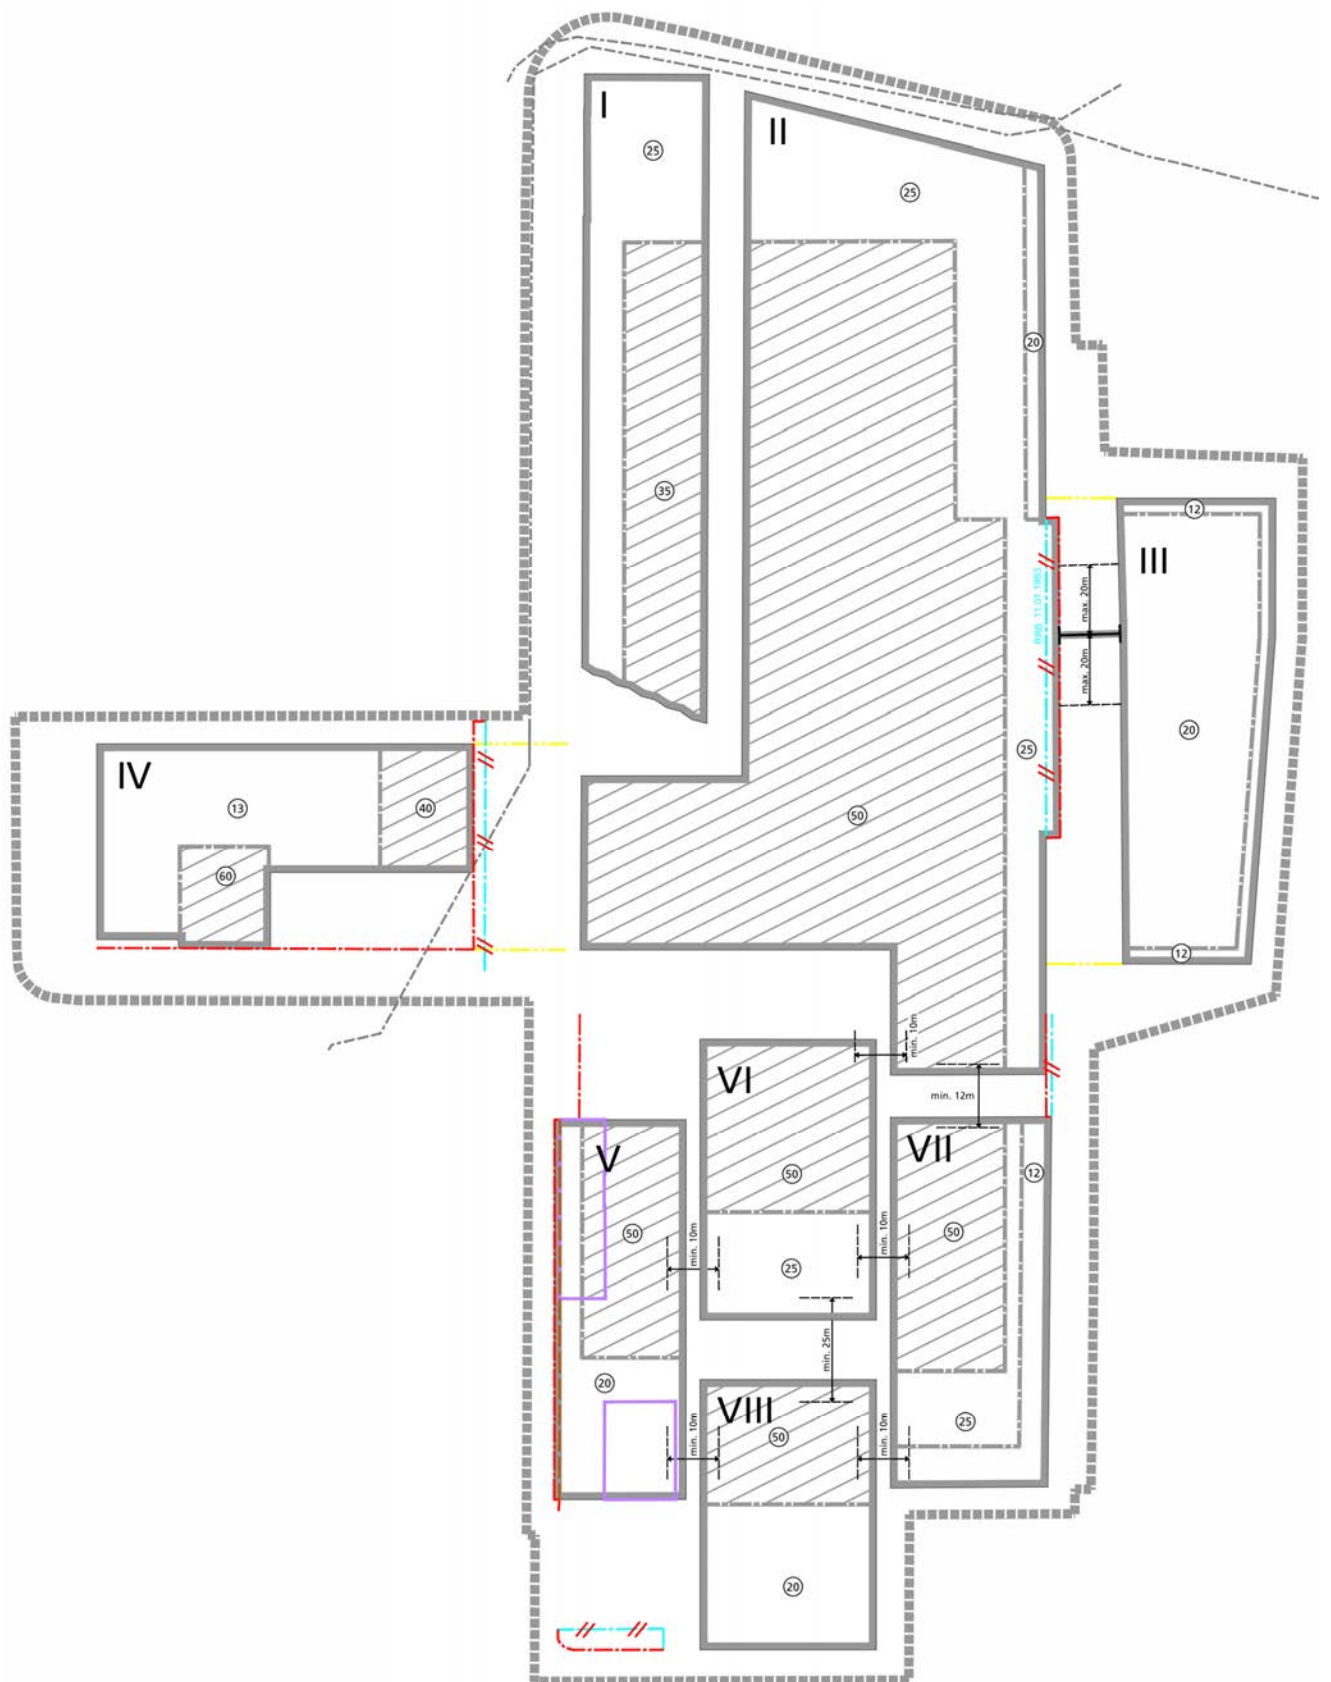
Übersicht Baubereiche mit max. Firsthöhe, Teilbereiche Hochhäuser zulässig (schraffiert), Baulinienänderungen und Mindestabstände gemäss Bebauungsplan
